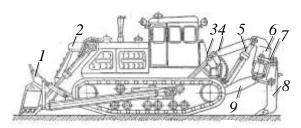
Бульдозер ДЗ-35 с рыхлителем ДП-22: *1* — бульдозерное оборудование; 2 — трактор; *3*, *9* — верхняя и нижняя рамы; *4* — верхняя тяга; 5 — гидроцилиндр; *6* — несущая балка; 7 — поворотный флюгер рыхлительного зуба; 8 — рыхлительный зуб
